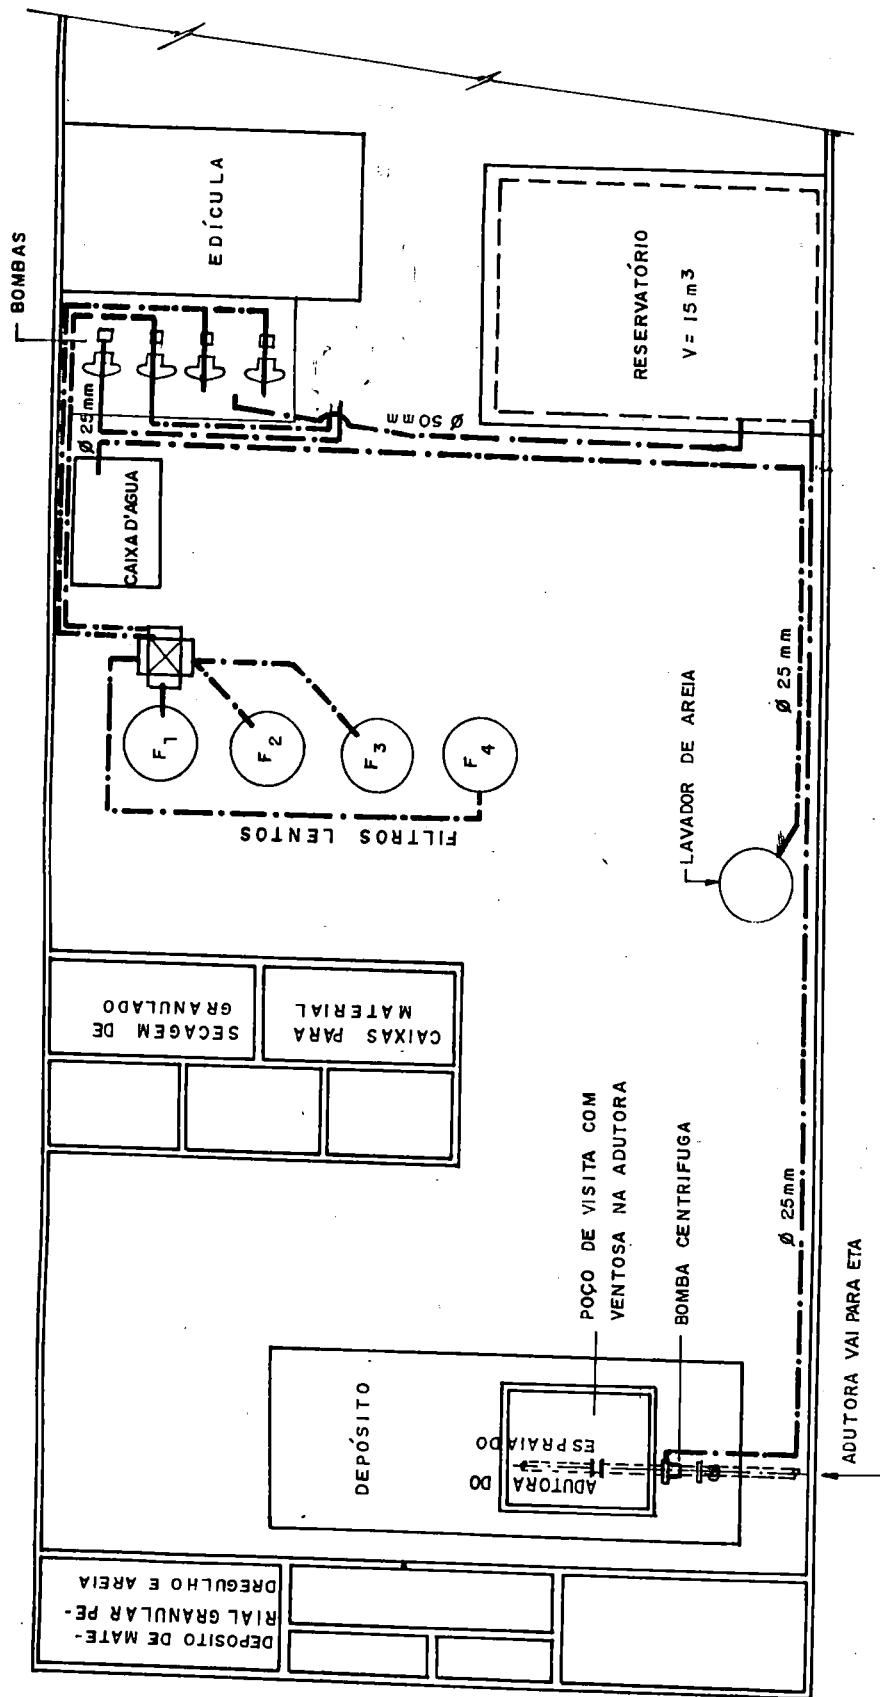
Planta Esquemática da Instalação - Piloto
